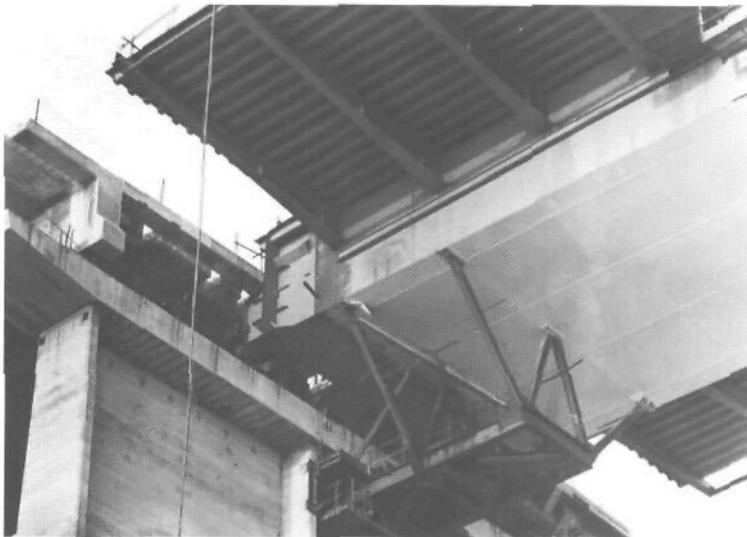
Dispositif provisoire placé sous le tablier pour assurer le guidage en cours de levage.
